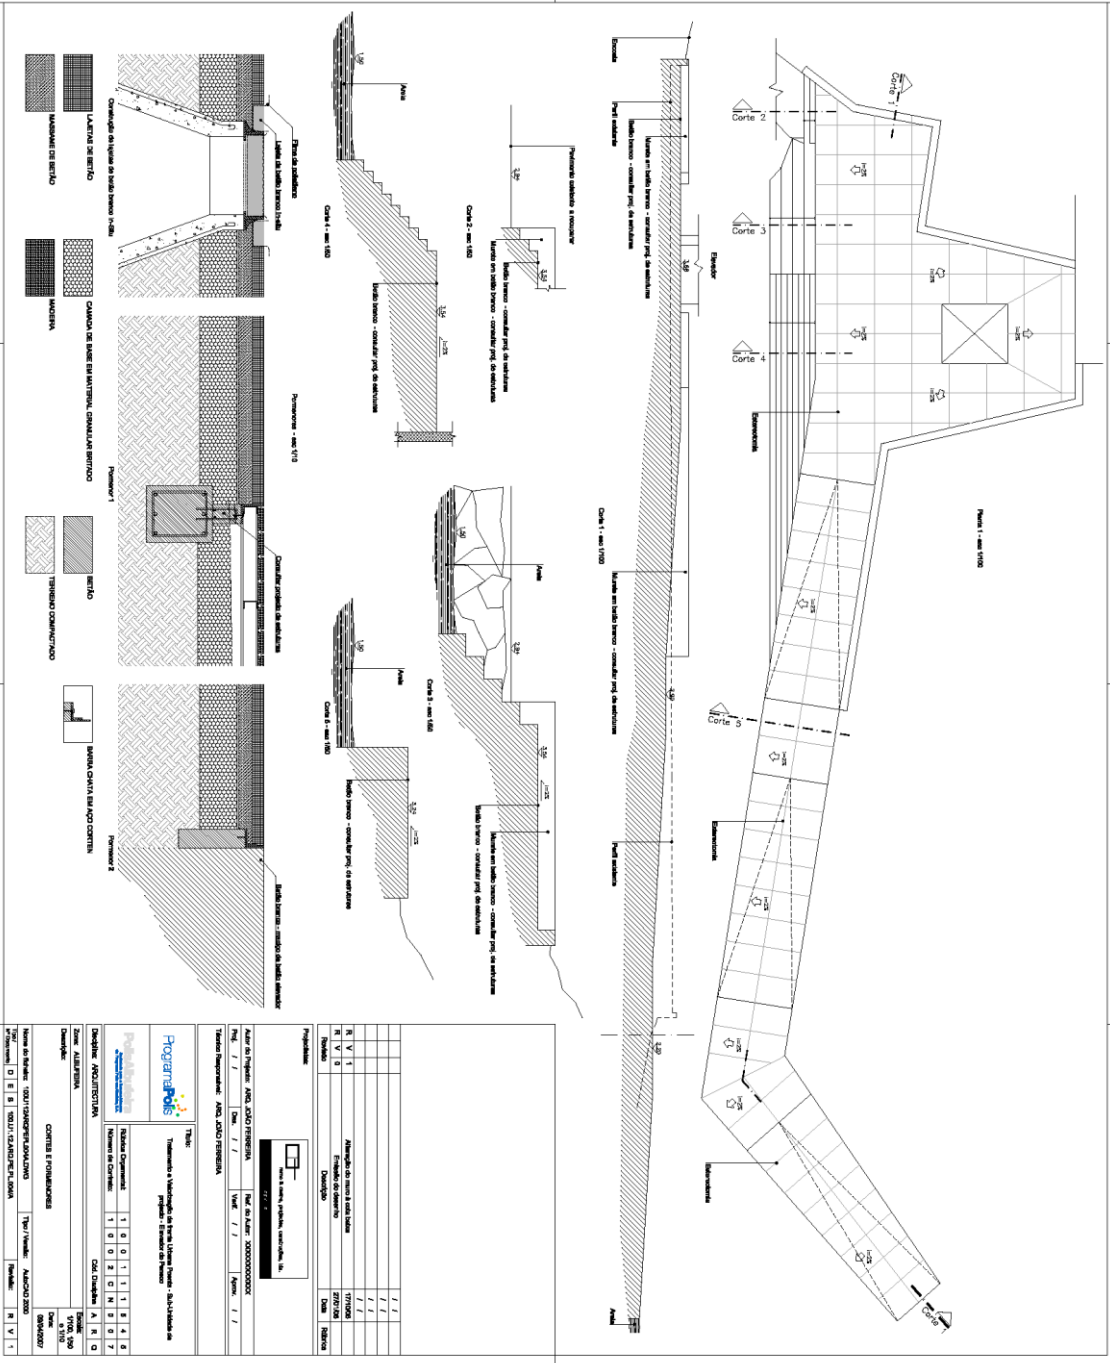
Pormenores construtivos da estrutura do elevador do Peneco. Fonte: Gabinete de arquitetura João Castro Ferreira
